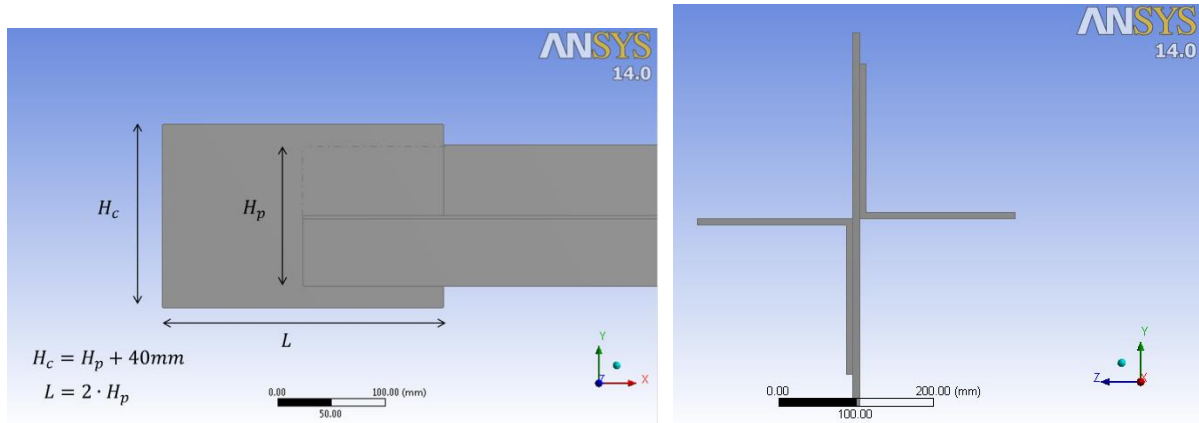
Geometría del modelo, dimensiones de la placa y vista frontal.
